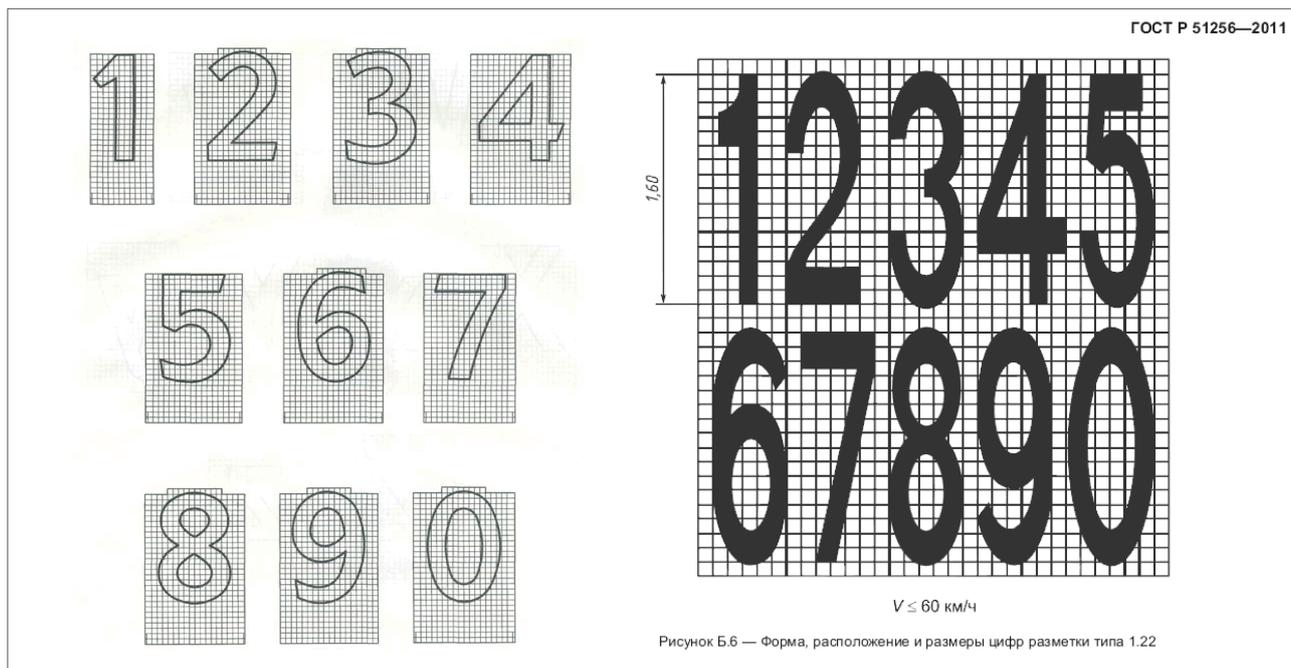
Форма, расположение и размеры цифр разметки типа 1.22
